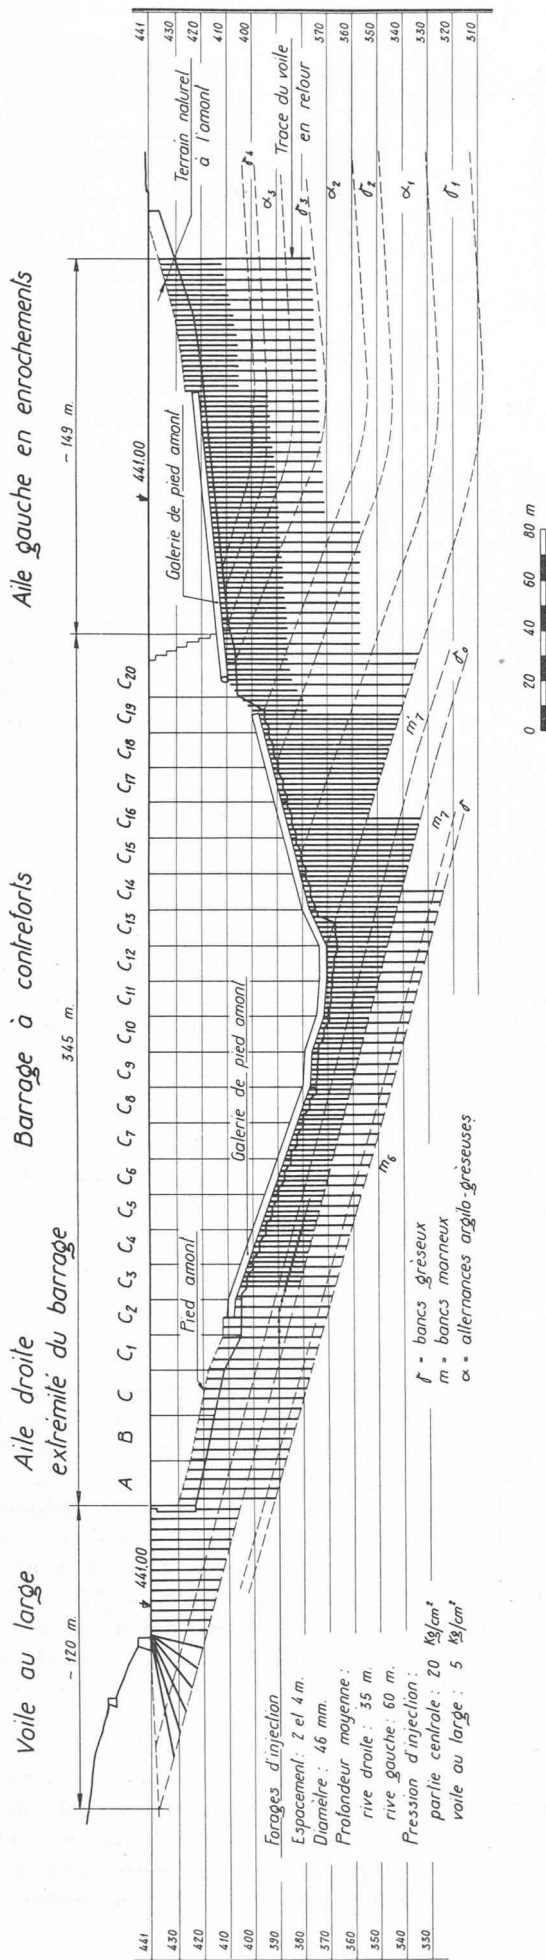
Etanchement et drainage du sol de fondation. — Elevation développée.
